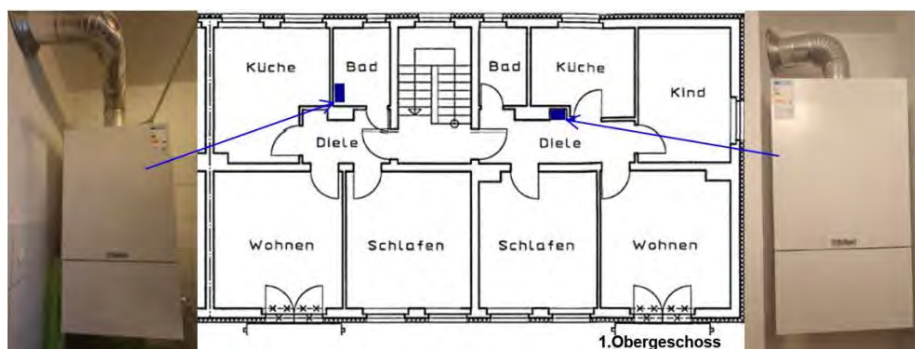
Grundriss mit Bestandsthermen. Quelle: Plan IME Essen (bearbeitet), Fotos IG Essen
